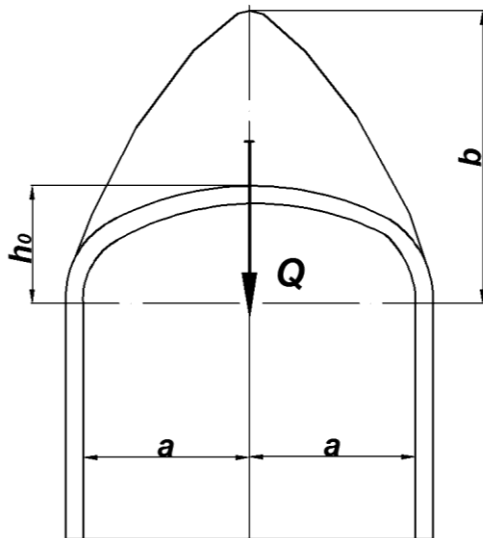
Схемы к расчету нагрузки на крепь при прямоугольно-сводчатой форме выработки
